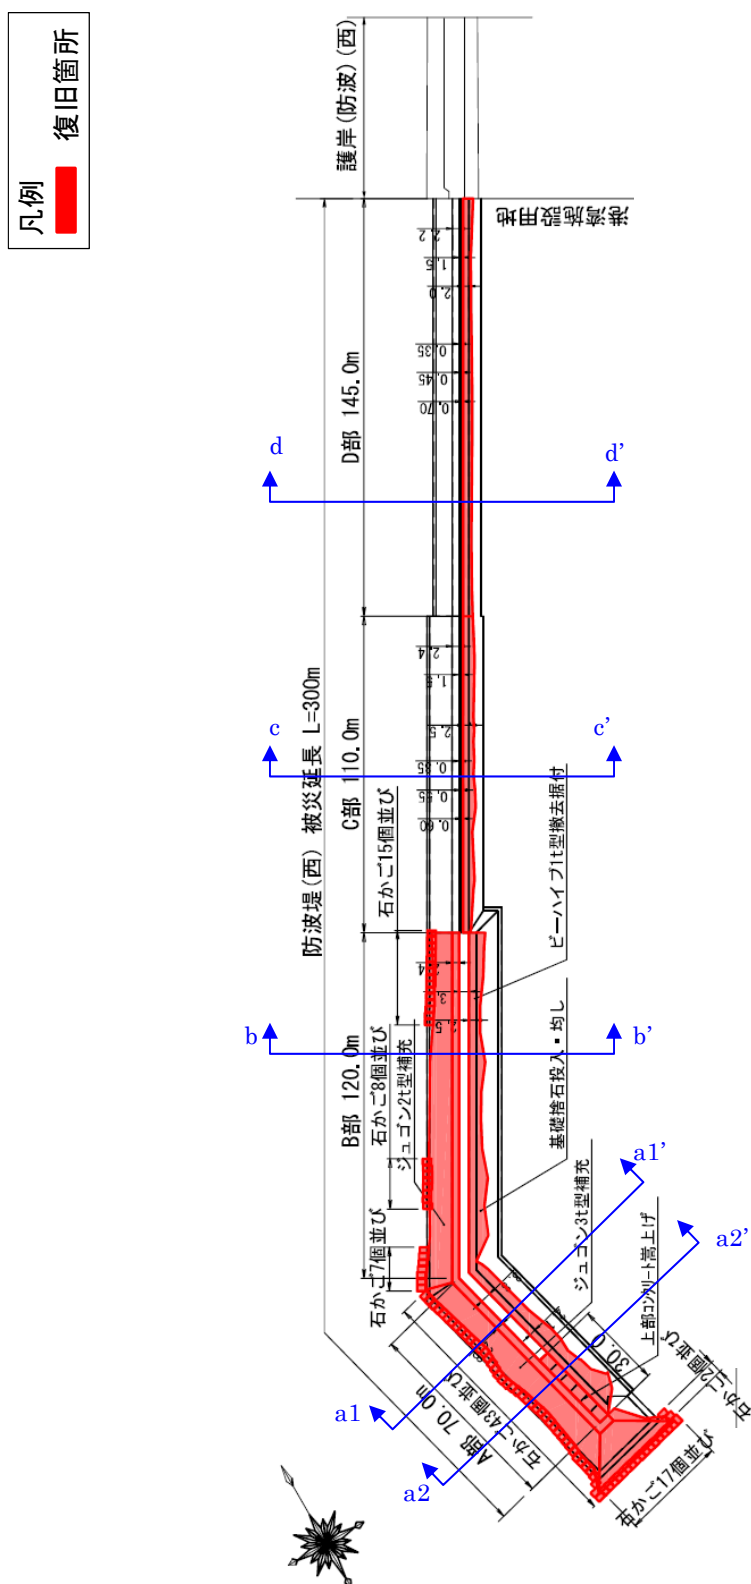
No.2 防波堤（西）の平面図（復旧後）
